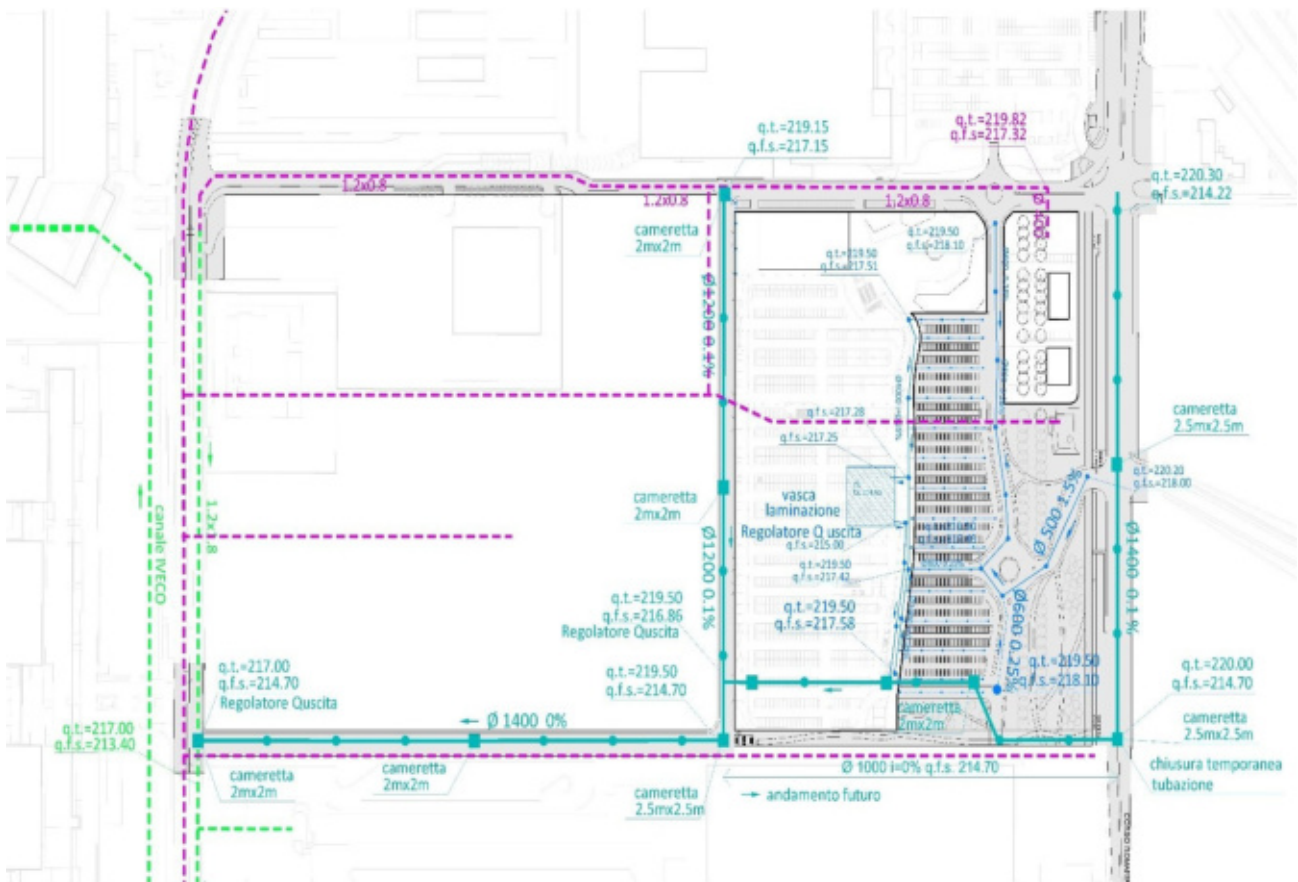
planimetria della rete di smaltimento acque meteoriche in progetto
